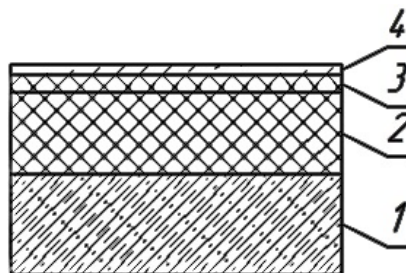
Эскиз конструкции чердачного перекрытия
